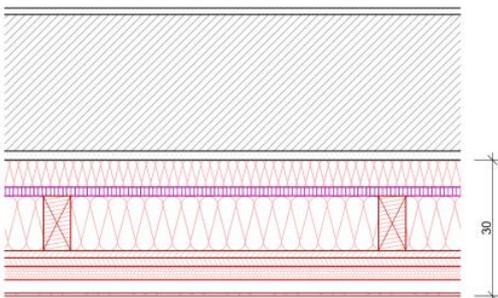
B&O Fassade Holztafelbau mit Stegträgern
